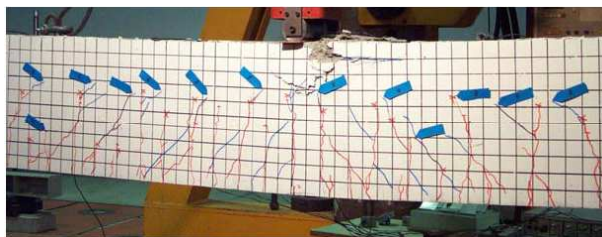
Poutre en flexion trois points. Profil de fissuration expérimental.
